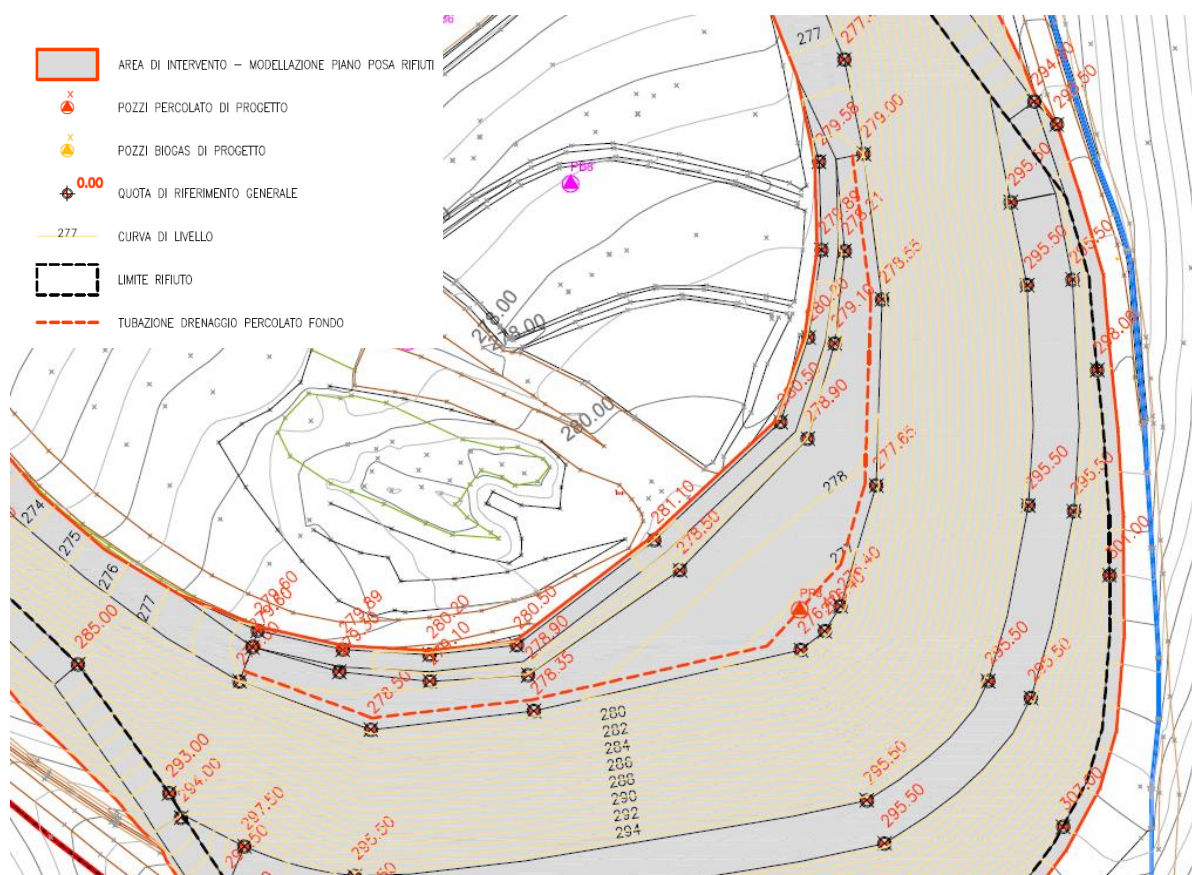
Planimetria con individuazione della linea di drenaggio del percolato sul fondo vasca
